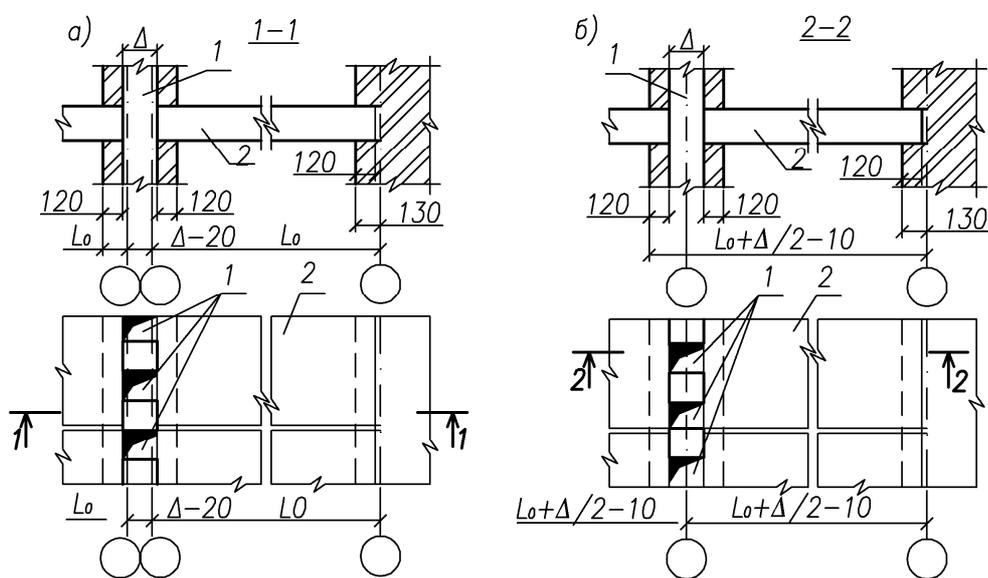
Примеры привязки к разбивочным осям внутренних стен с вентиляционными каналами:
